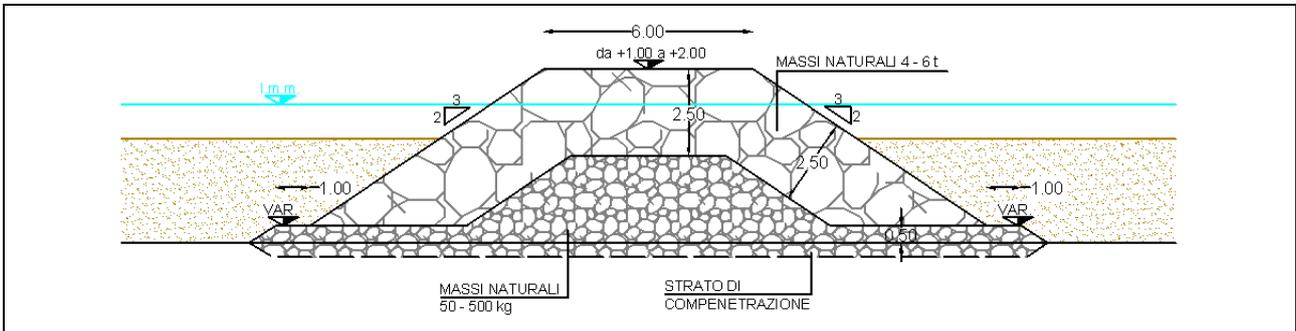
Sezione tipologica 3 – Tratto di raccordo del trasversale
